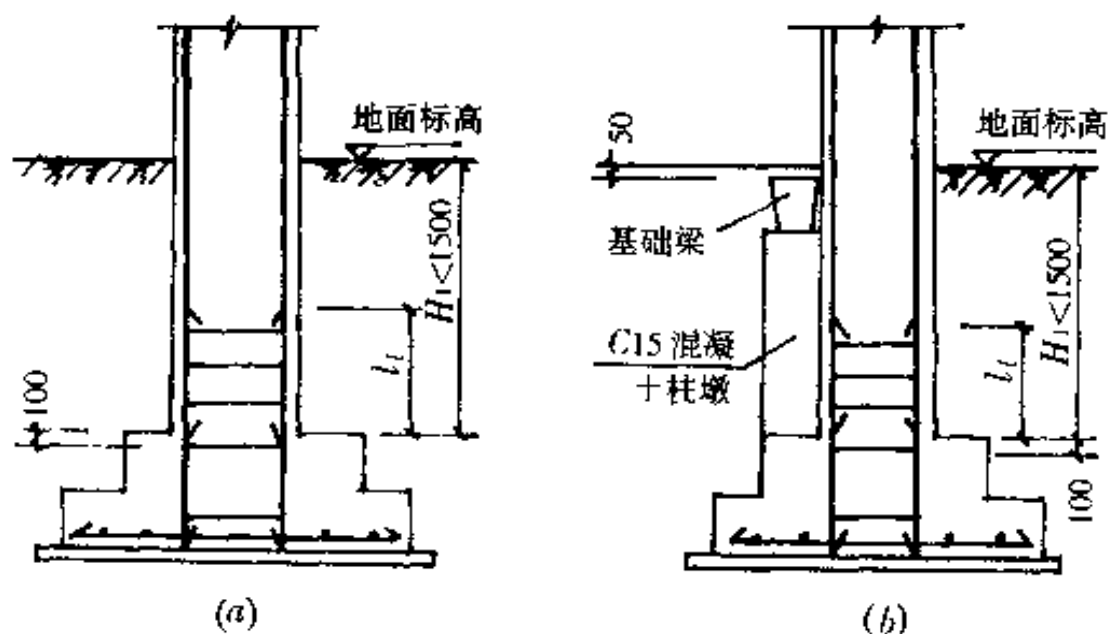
基础中插筋与柱中纵向钢筋搭接位置(1)
